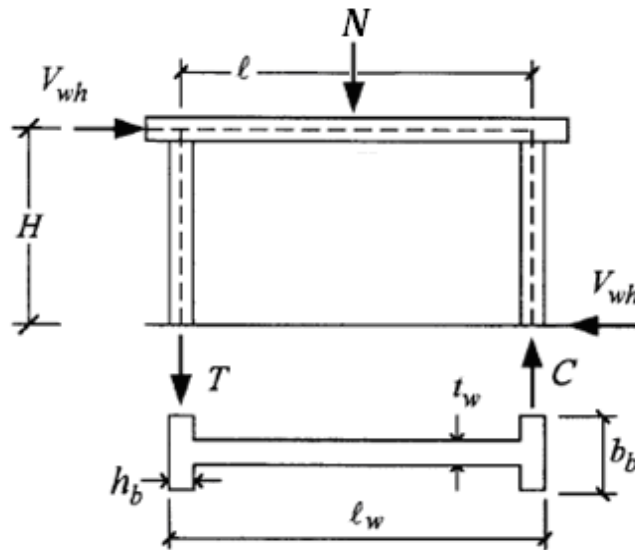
Acciones externas de muros cortos de hormigón Armado (Hwang et al. 2001)
